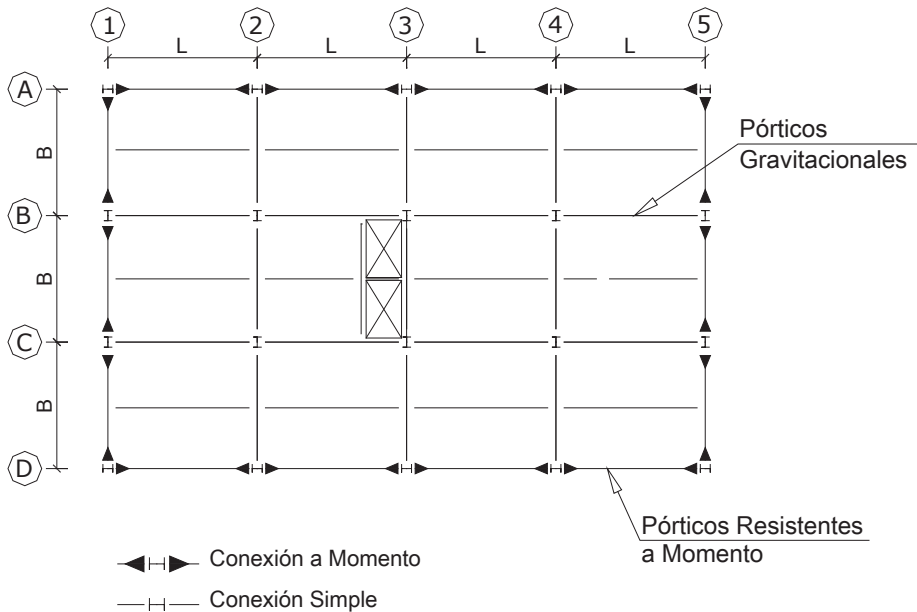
Planta de Edificio de Acero Estructural Compuesto por Pórticos Resistentes a Momento y Gravitacionales
